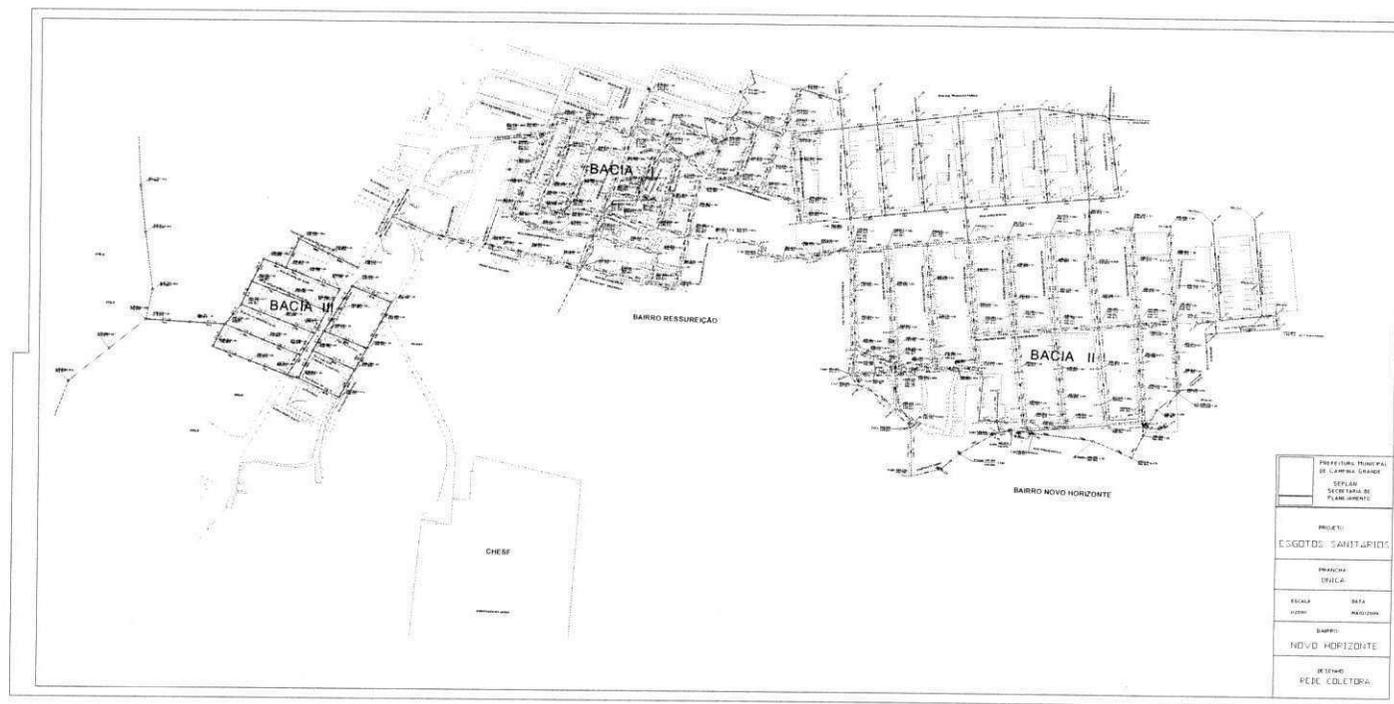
Planta da rede coletora - Bairro do Novo Horizonte
